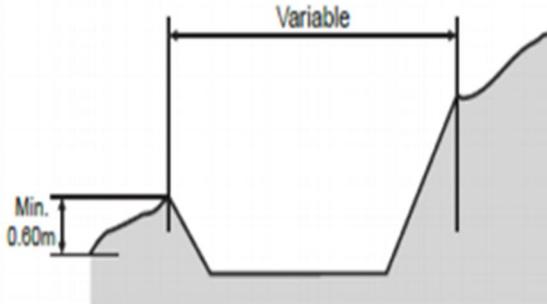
Canal perimetral trapezoidal para desvío de aguas pluviales
